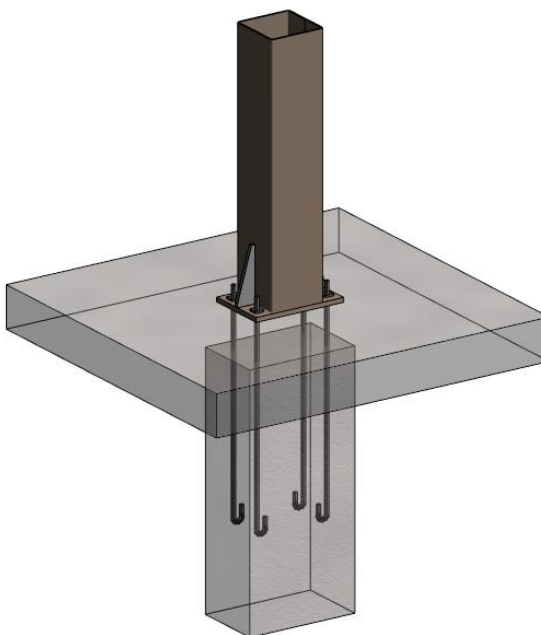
Pormenor de ligação da base de um pilar metálico.
